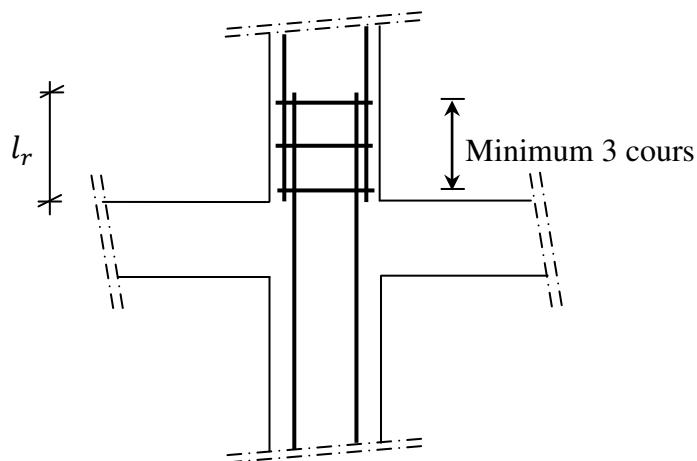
Les armatures transversales dans la zone de recouvrement
